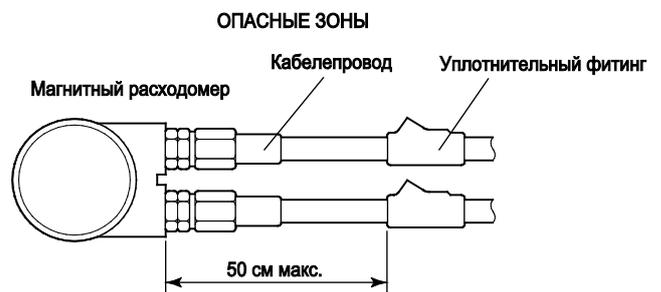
Прокладка электропроводки в кабелепроводе
